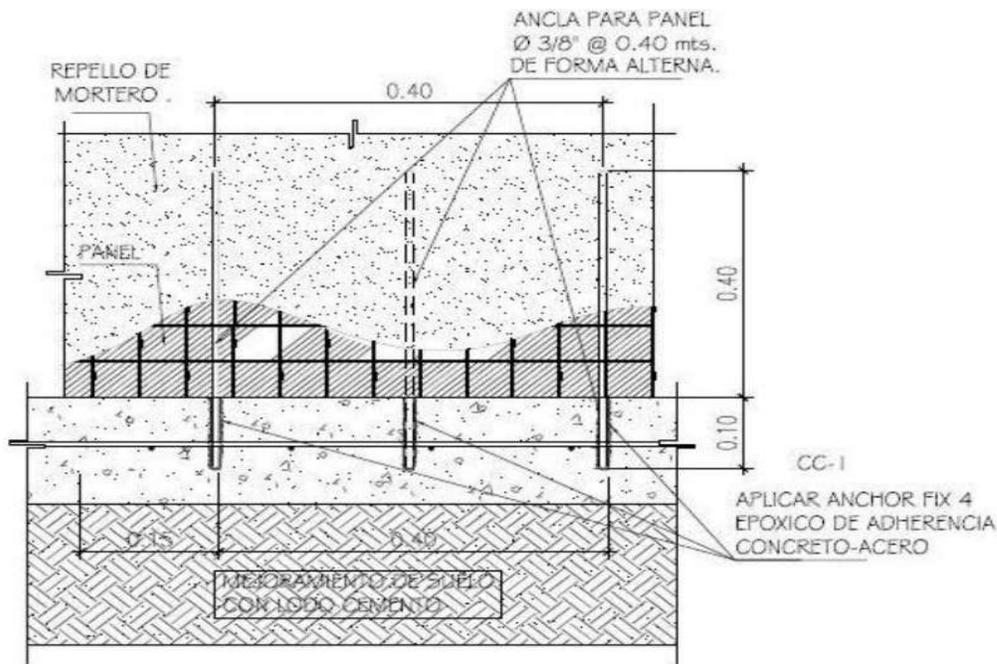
Detalle de anclaje de panel a cimiento. Perforación posterior
